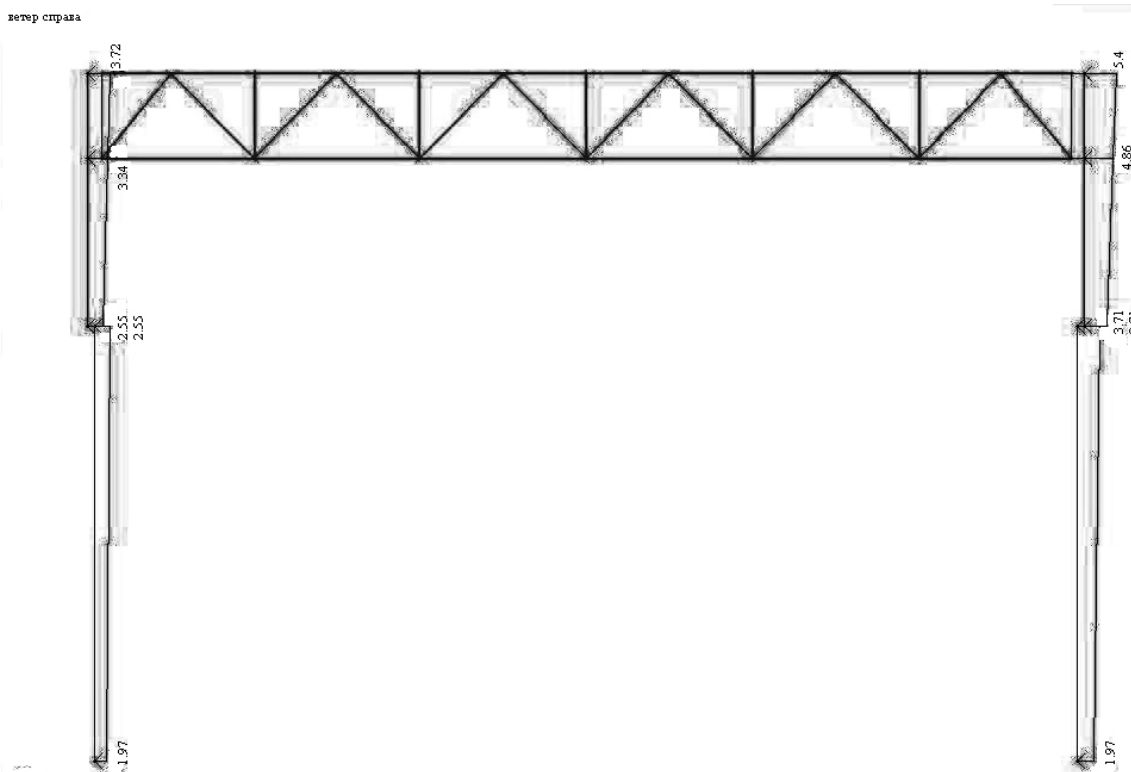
Расчетная схема после задания нагрузок загрузения 9
